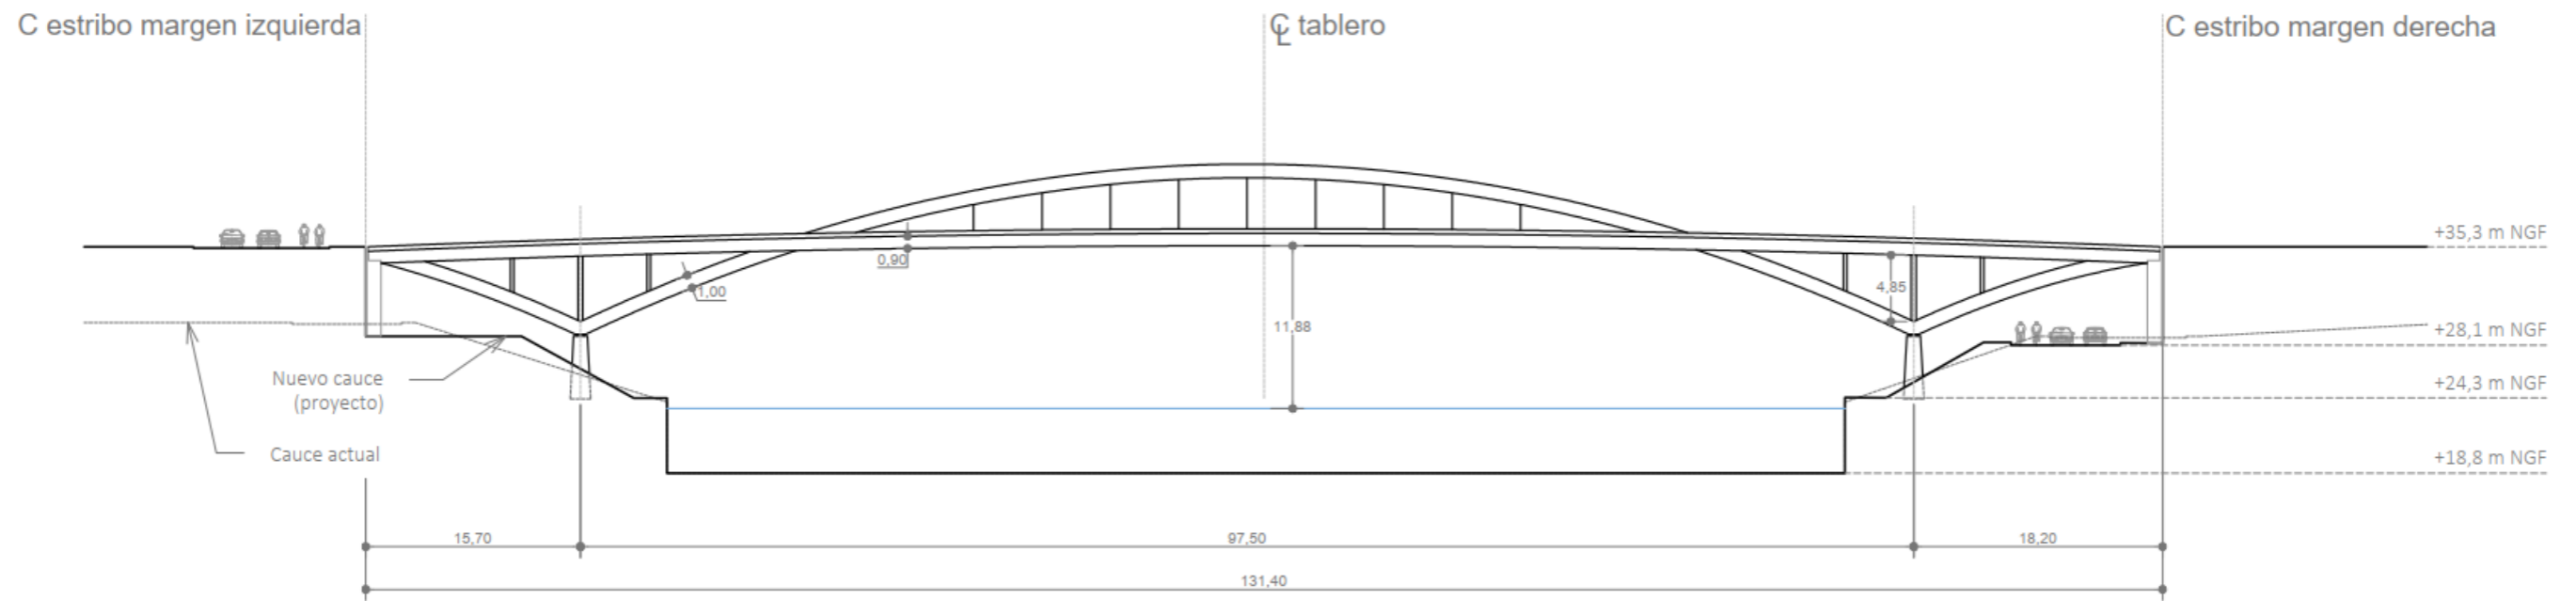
Sección longitudinal alternativa 2 puente arco (fuente: elaboración propia)
